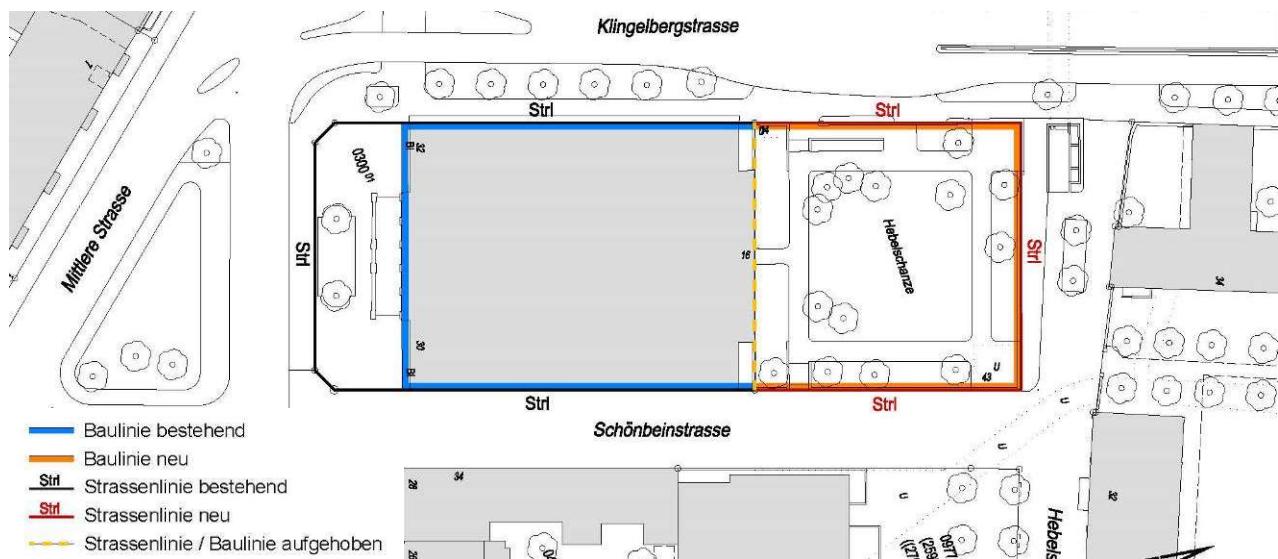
Plan-Nr. 14'284 / Bau- und Strassenlinienplan (nicht genordnet)
